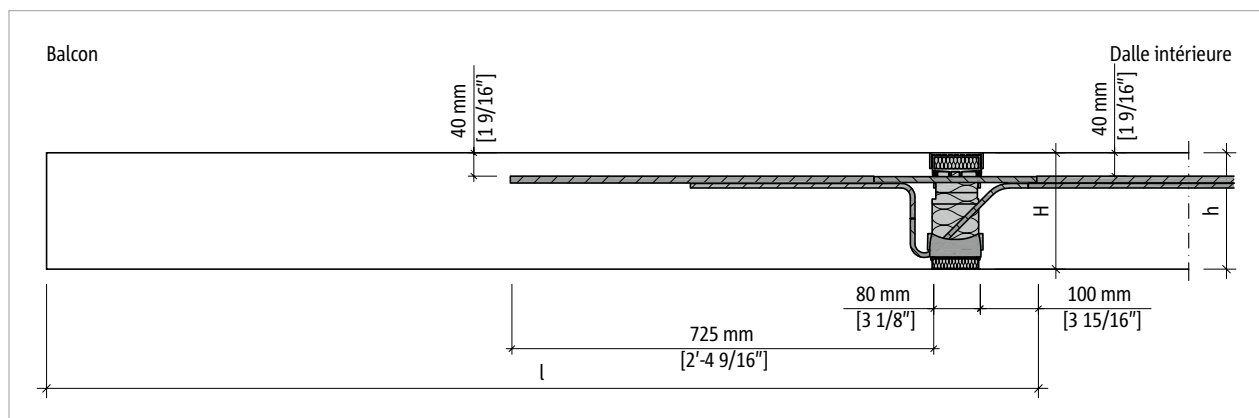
Schöck Isokorb® T Type CK : Recouvrement de béton CV40 (1,5") avec dalle de balcon plate
